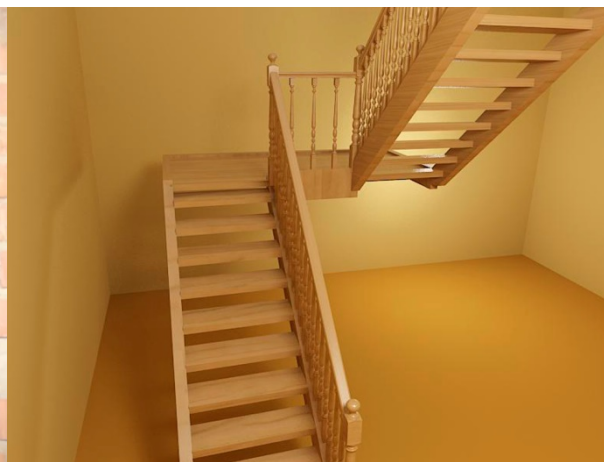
Двухмаршевая деревянная лестница для индивидуального жилого дома.
